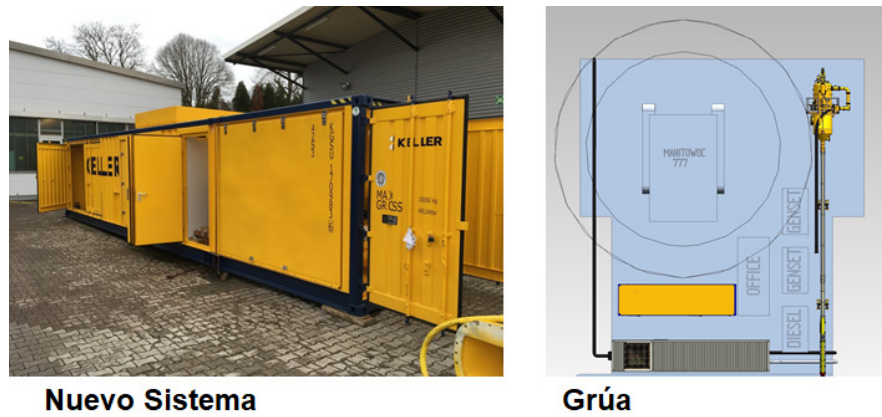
Contenedor principal del sistema y vista en planta de la barcaza.
